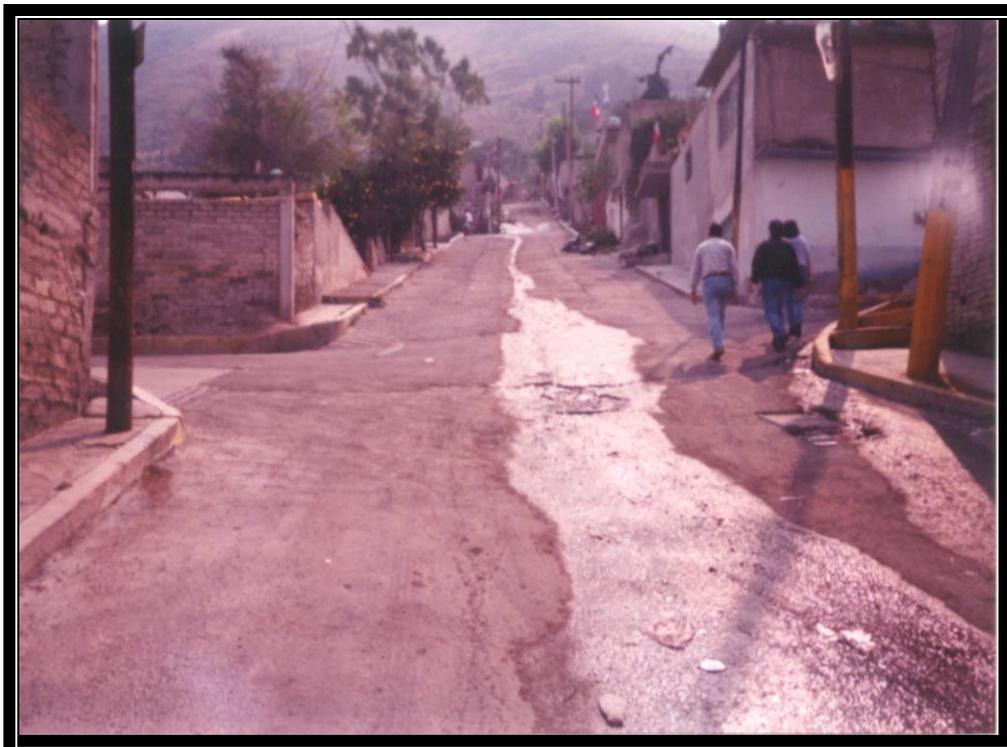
Trazo de la línea de proyecto sobre la calle Benito Juárez, vista desde la calle Tenochtitlan
